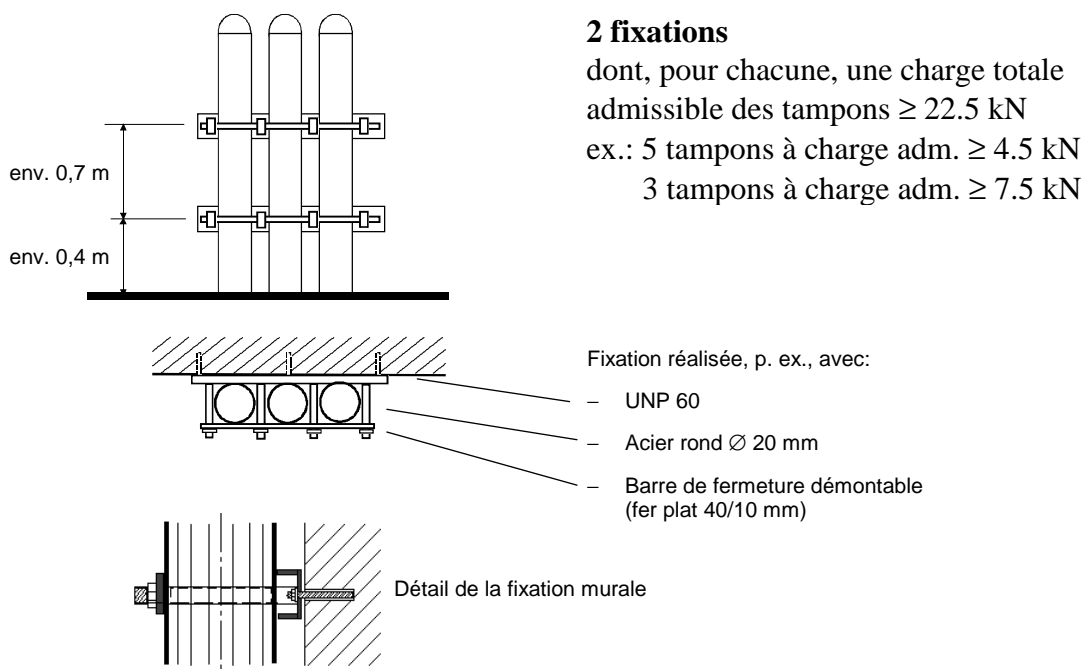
Fixation murale pour 3 bouteilles de gaz sur rampe (avec 2 fixations pour 1 x 3 bouteilles)
